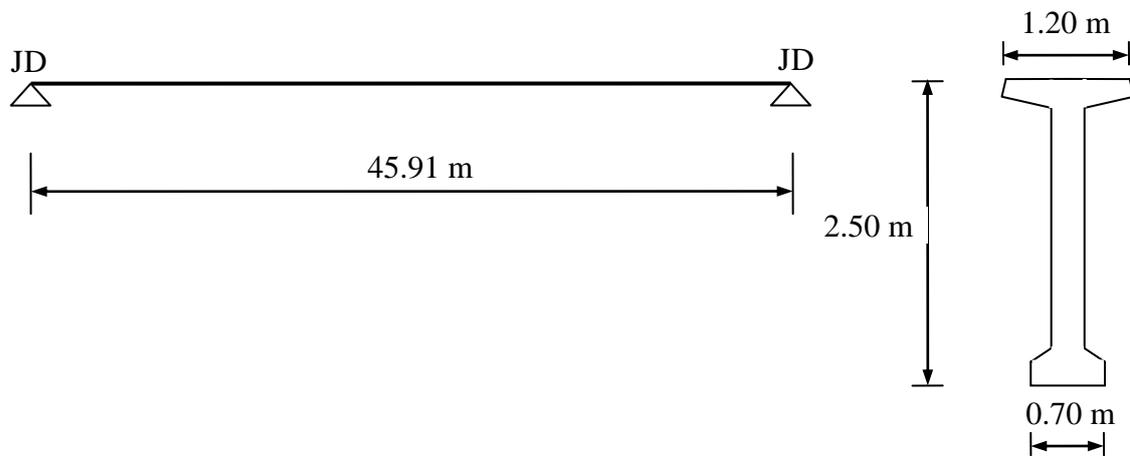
Esquema estático de las vigas del sector A del Puente General Artigas (tramo típico representativo de vanos 1 a 9)
